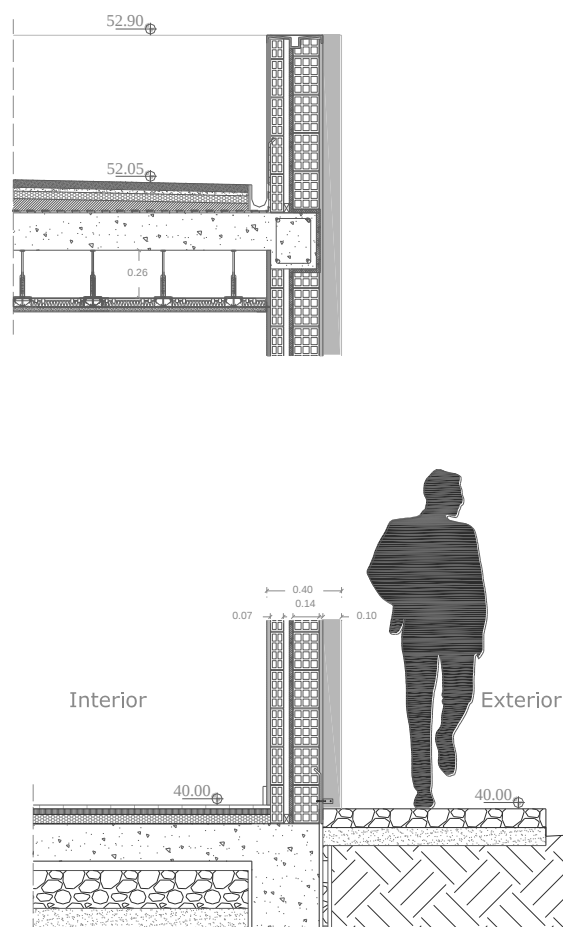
Detalhes: Parede exterior | Cobertura | Pavimento
